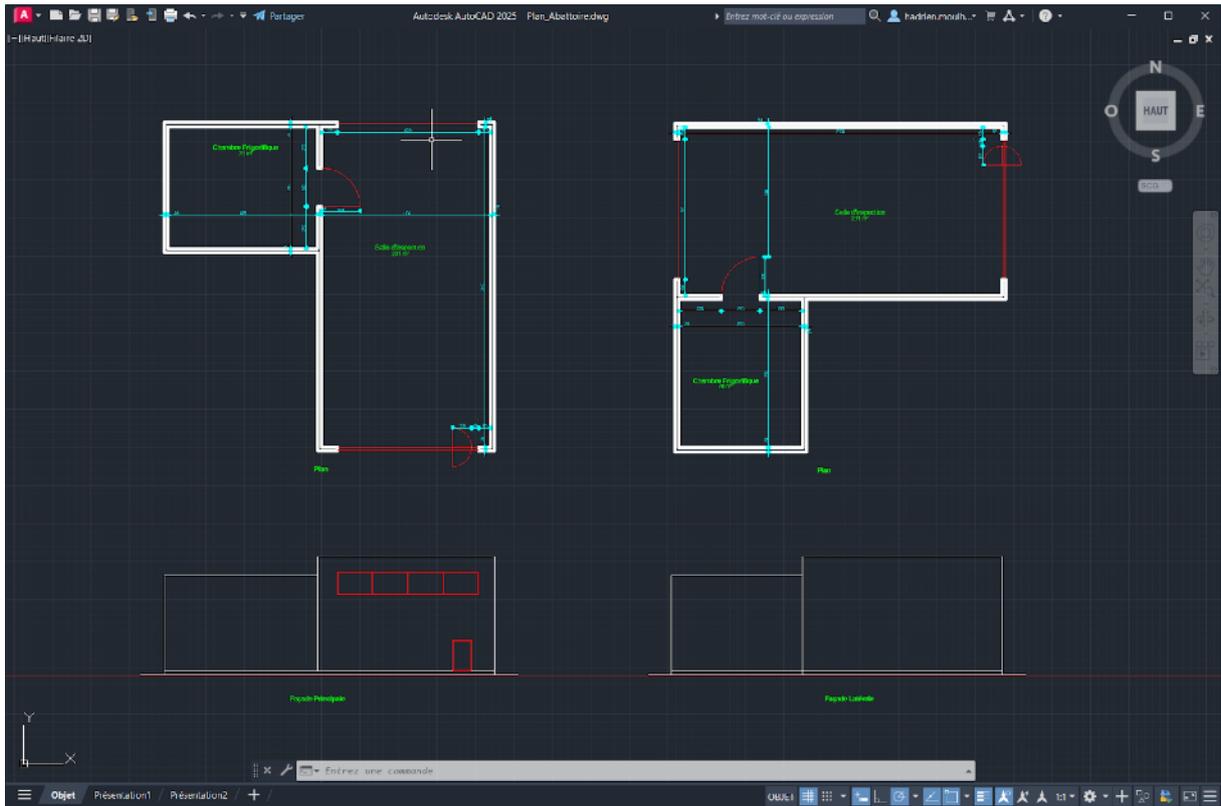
Présentation des plan de l'abattoir constituant le jeu conçu sur AutoCAD (Photo personnelle,2024)
